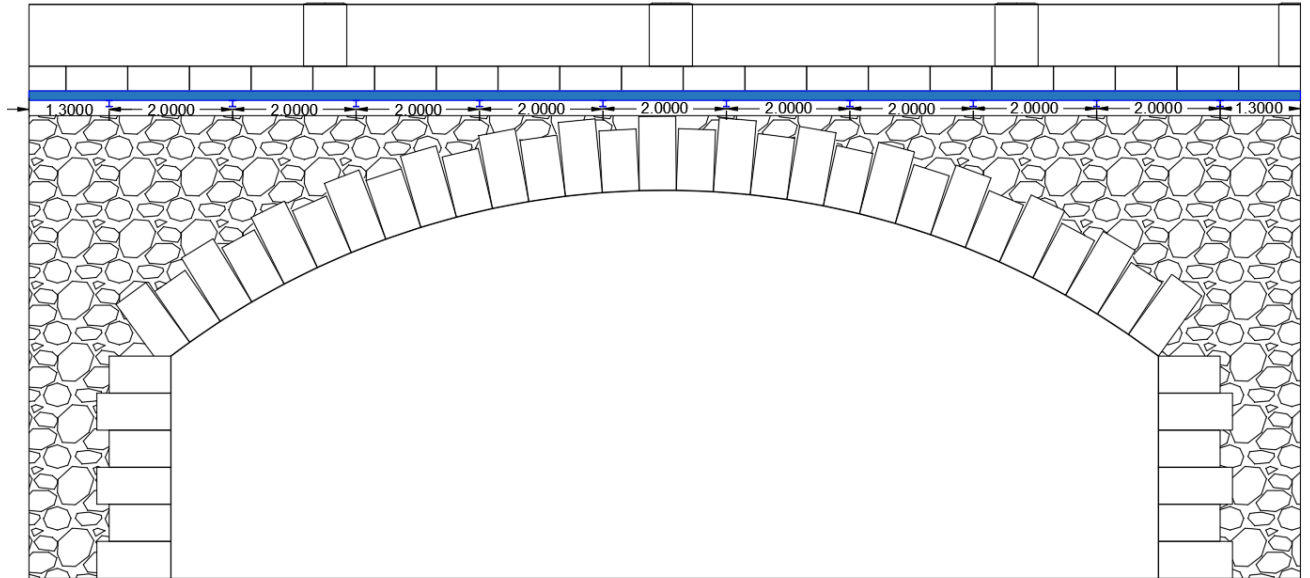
Representação esquemática da proposta nº1 – Vigas metálicas
